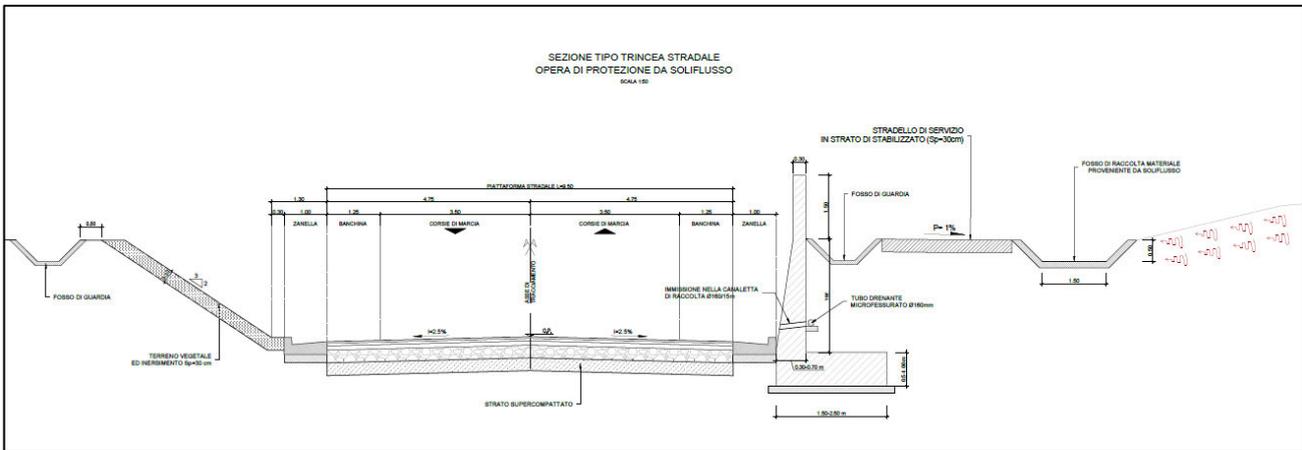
Sezione tipo trincea stradale – opera di protezione da soliflusso
